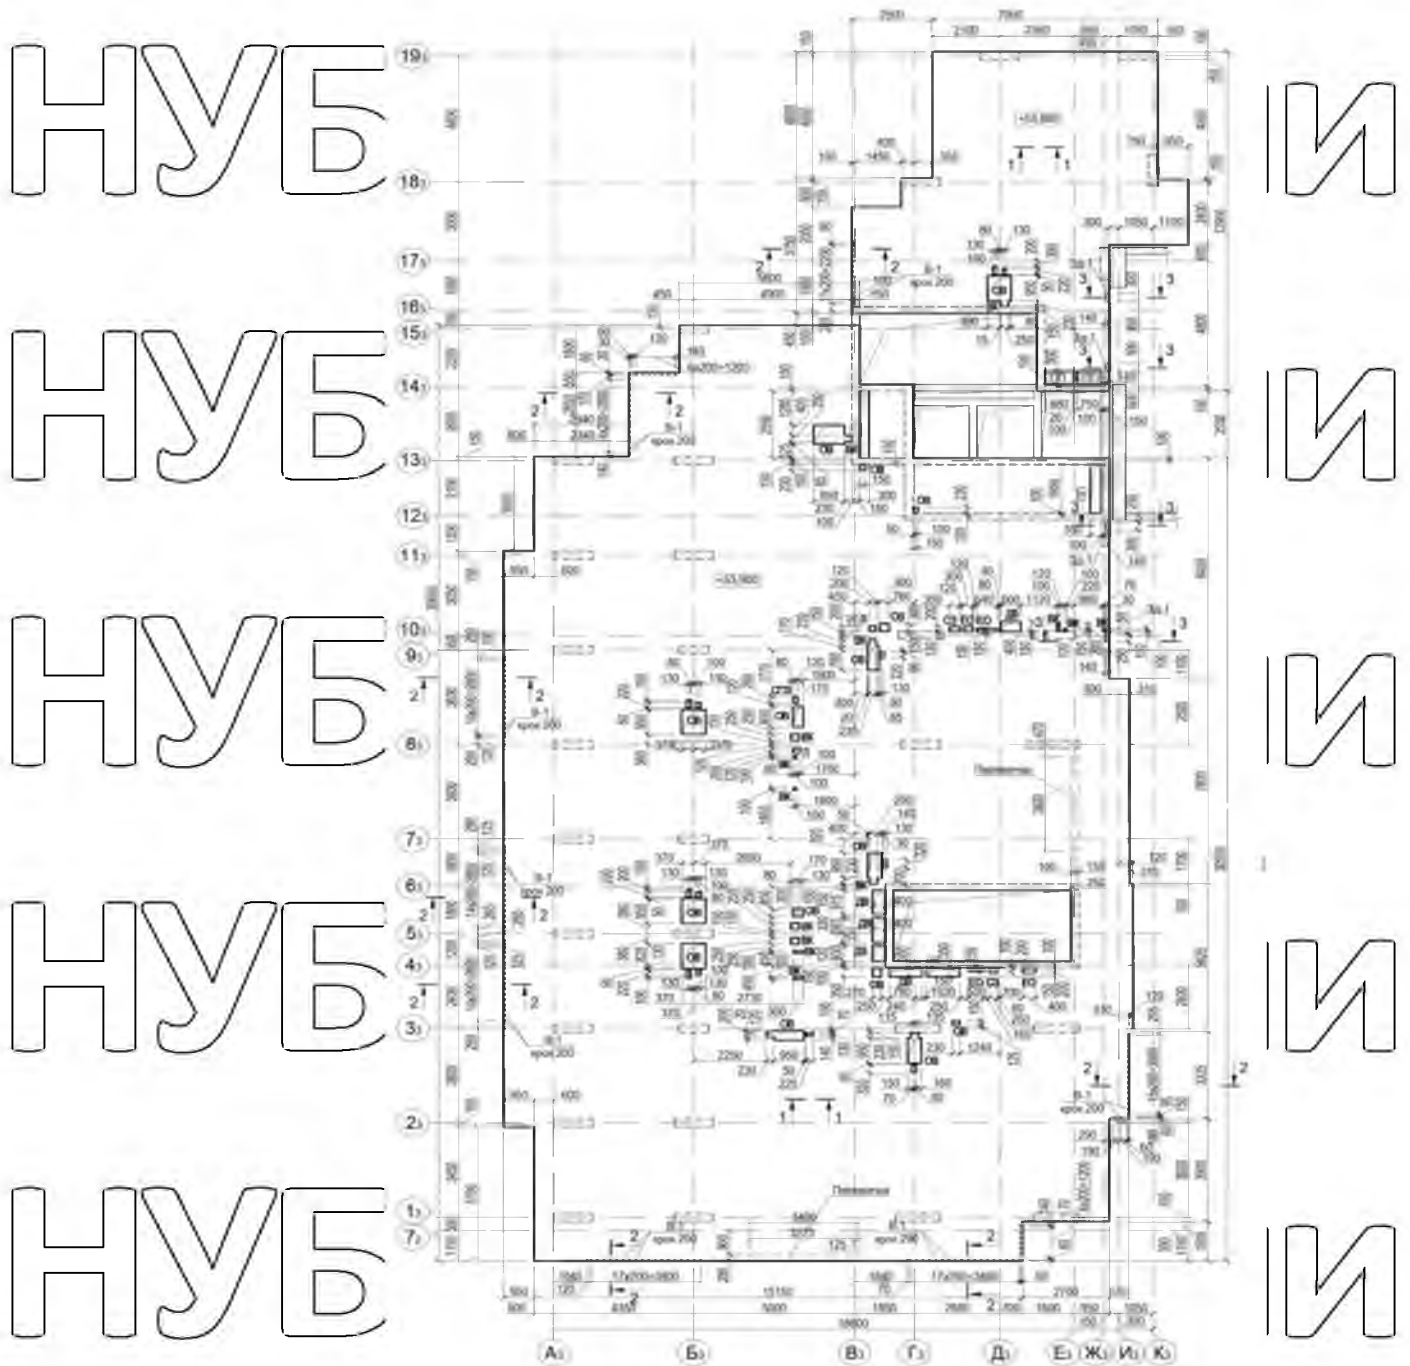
Опалубне креслення 3/Б плити перекриття типового поверху
